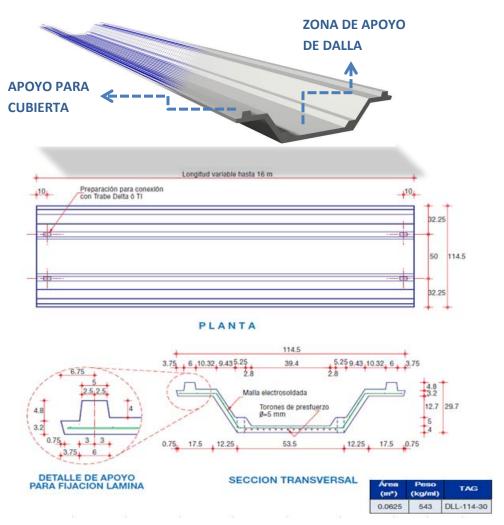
Isométrico con geometría y esquema de armado para larguero tipo Dalla.
